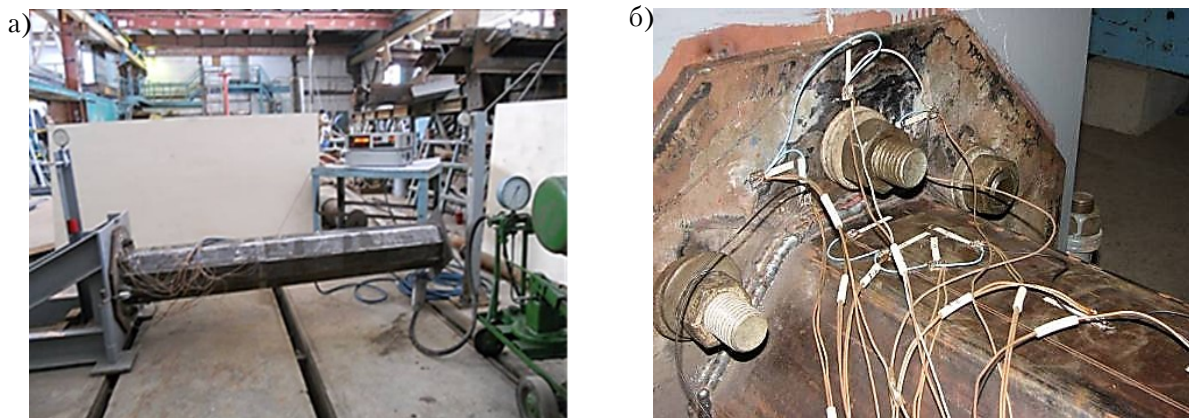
Исследование НДС фланцевого соединения: а) общий вид испытательной установки; б) сжатая зона стойки и растяжения фланца.
